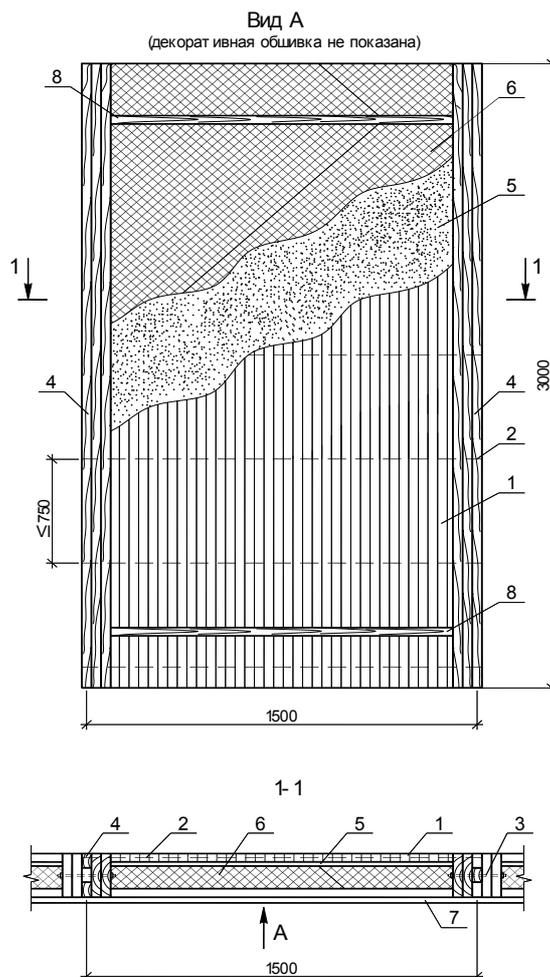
Пример конструкции стеновой панели из клееных блоков П-образного сечения: 1 – П-образный клееный блок; 2 – поперечные арматурные стержни; 3 – соединительная шпилька; 4 – соединительные элементы; 5 – пароизоляция; 6 – утеплитель; 7 – внешняя декоративная обшивка; 8 – диафрагма жесткости
